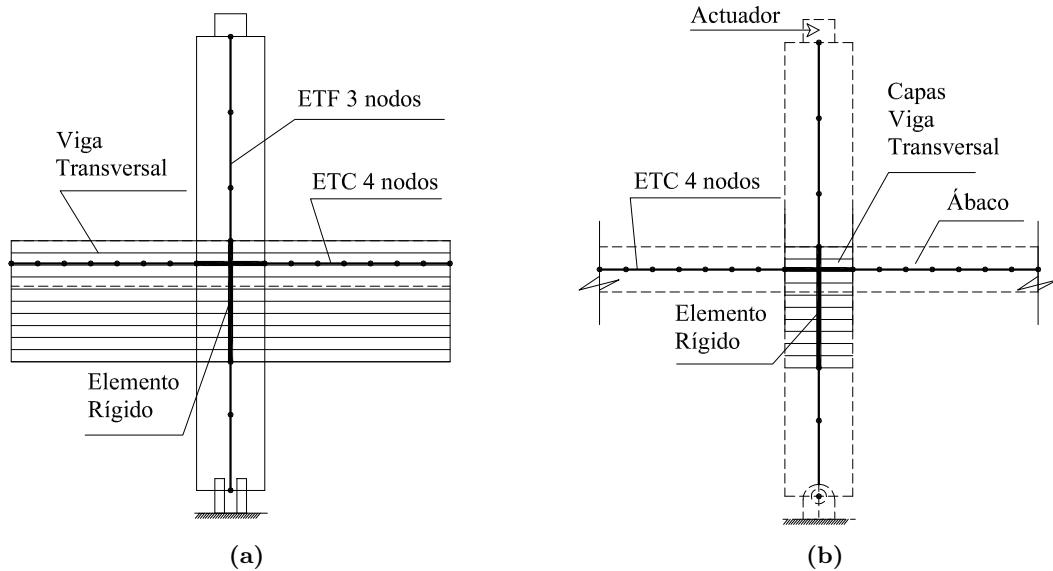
MEF de conexiones interiores pila-placa de forjado reticular con vigas transversales descolgadas: (a) Sección longitudinal de la viga (perpendicular a la dirección de carga) y (b) Sección transversal de la viga (paralela a la dirección de carga)
